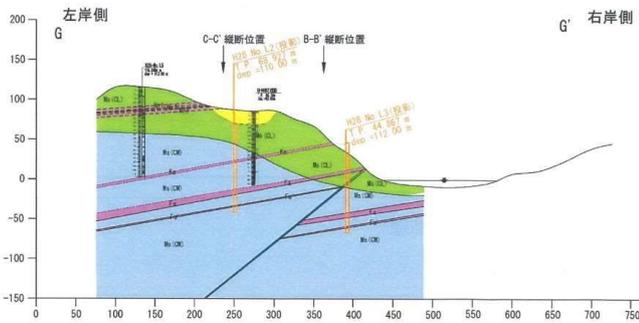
地質断面図 第二床固工上流 (G-G' 断面)
